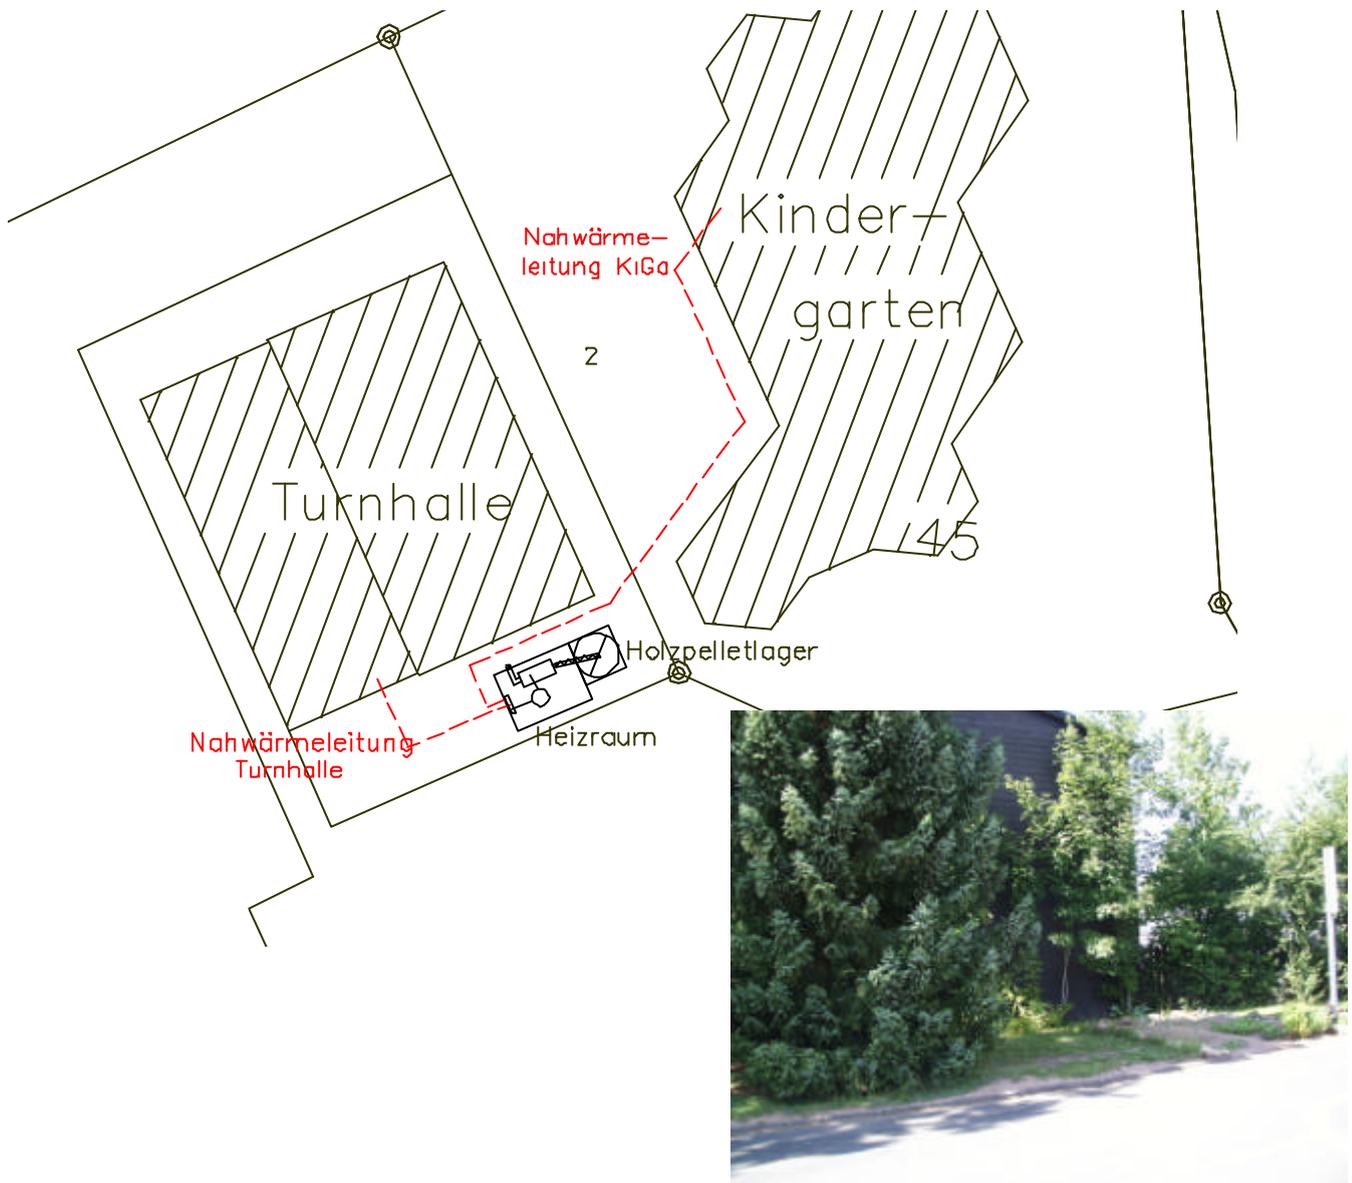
Lageplan mit Heiz- und Lagerraum (nicht maßstäblich)
